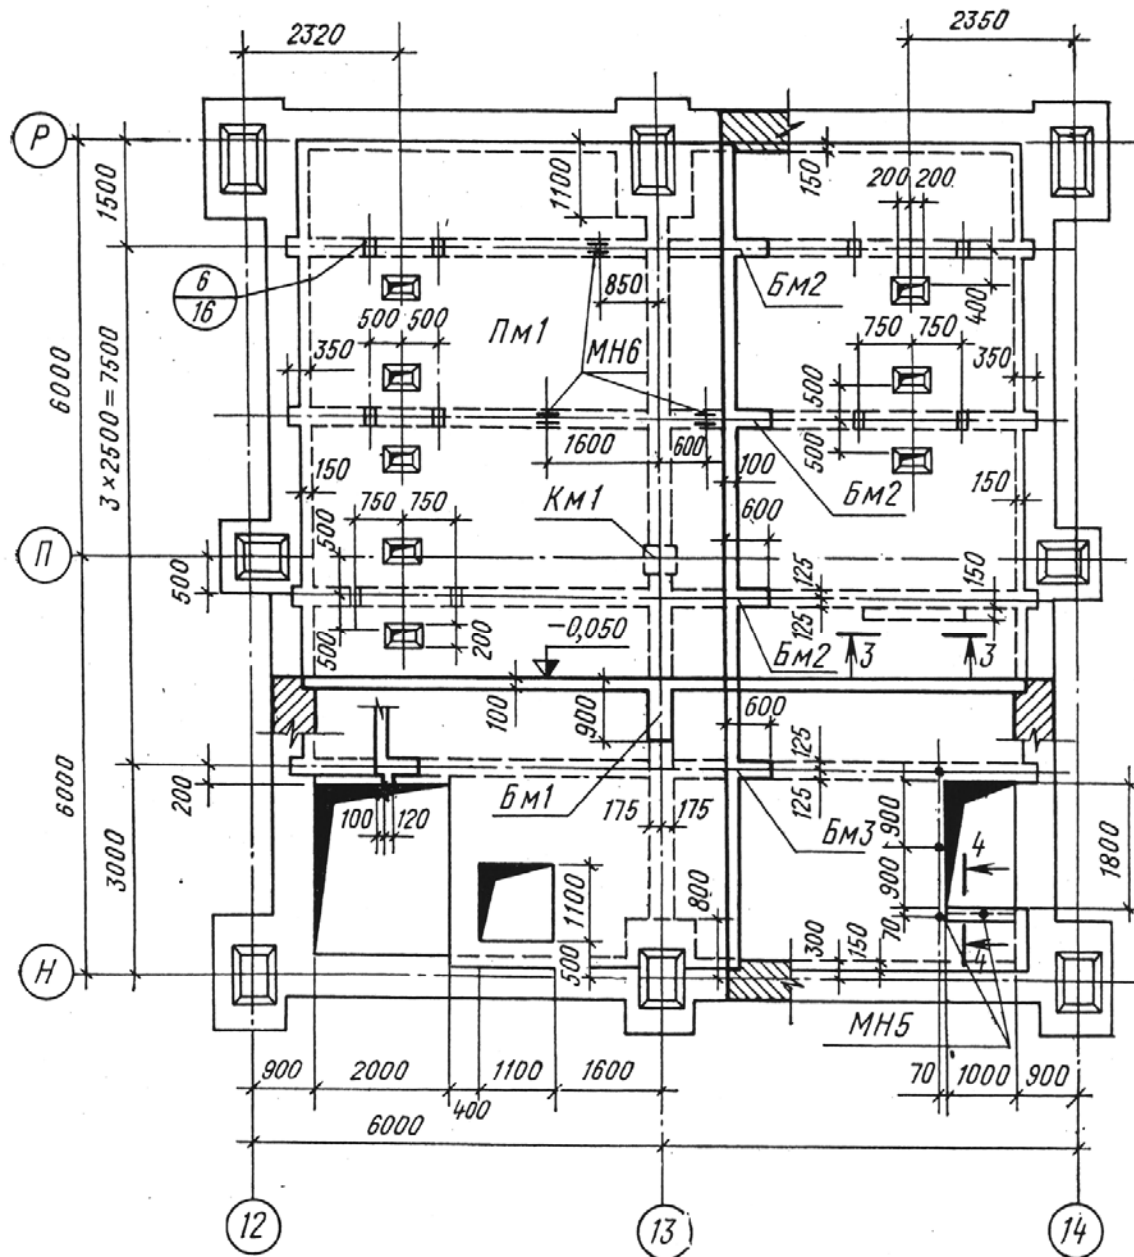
Перекрытие на отм. 0,000 РКМ5
